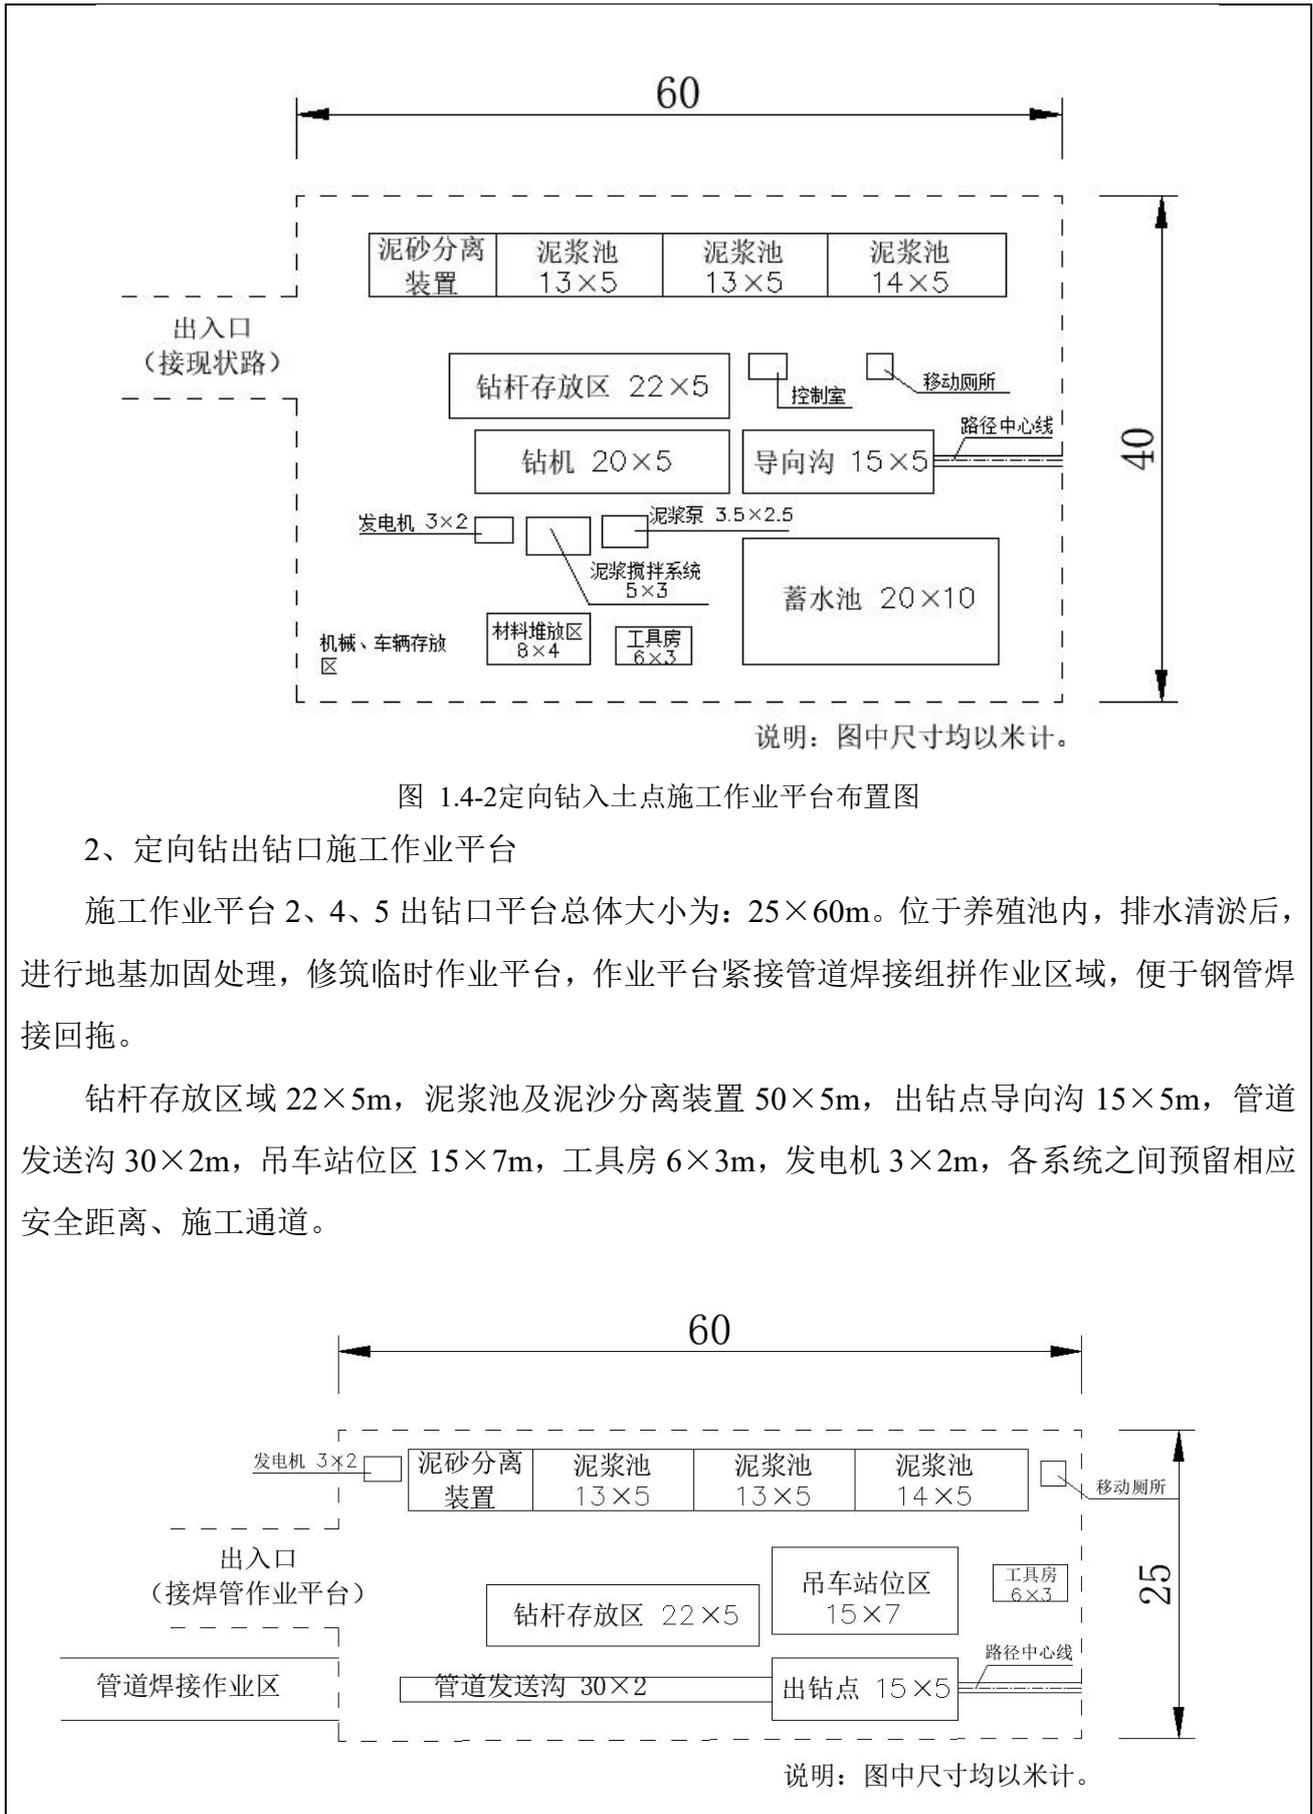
施工作业平台2、4、5出钻口平台布置图
